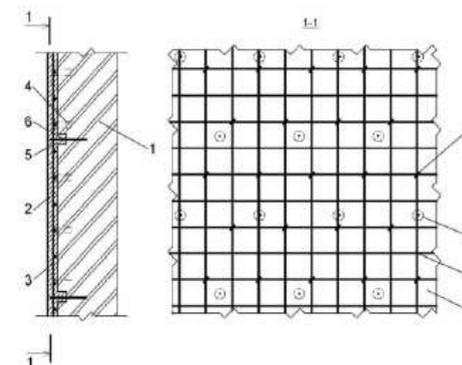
Схема усиления каменной кладки железобетонной рубашкой со шпонками.
